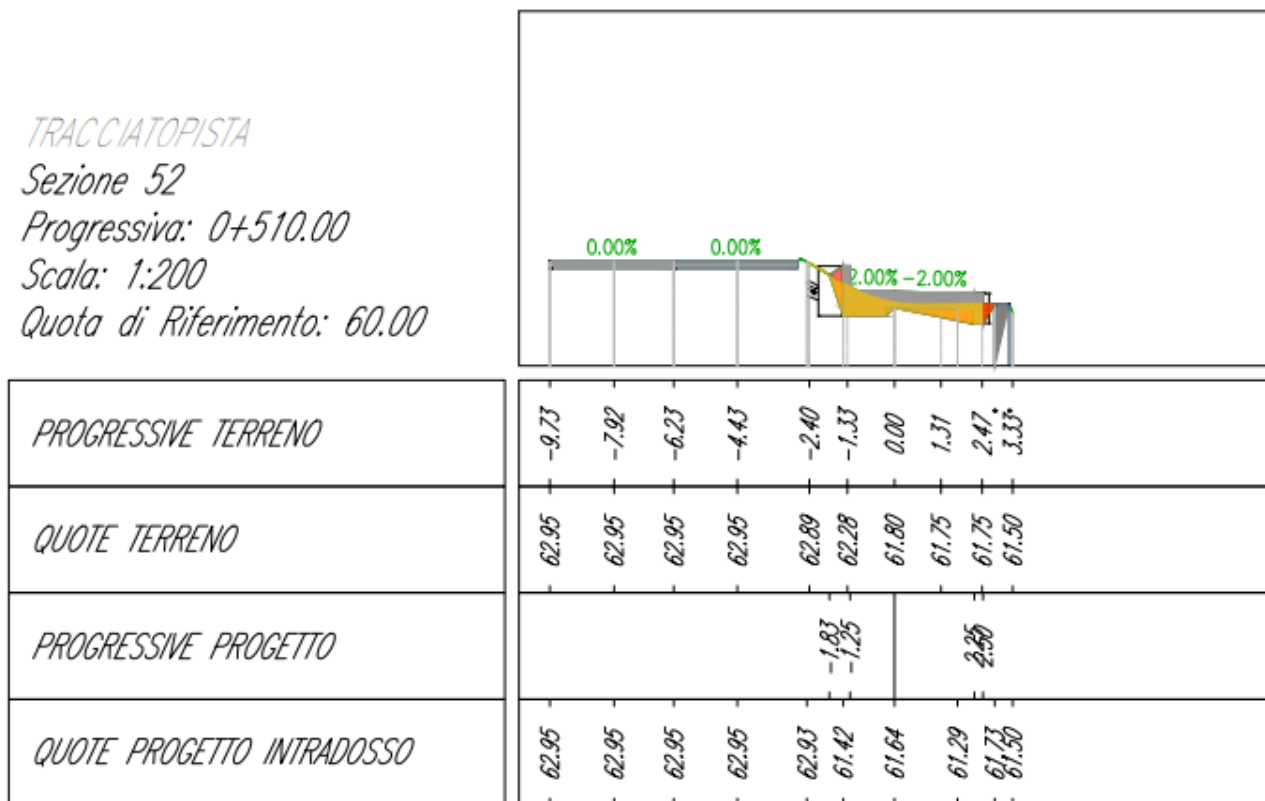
Tratta L3 – Microtratta Naviglio pavese – sezione trasversale n.52
